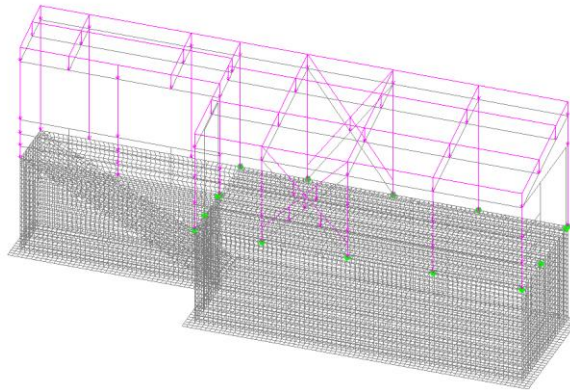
Расчетная модель монолитной лестницы по грунту, нагруженная весом перекрытия (вариант №2)
